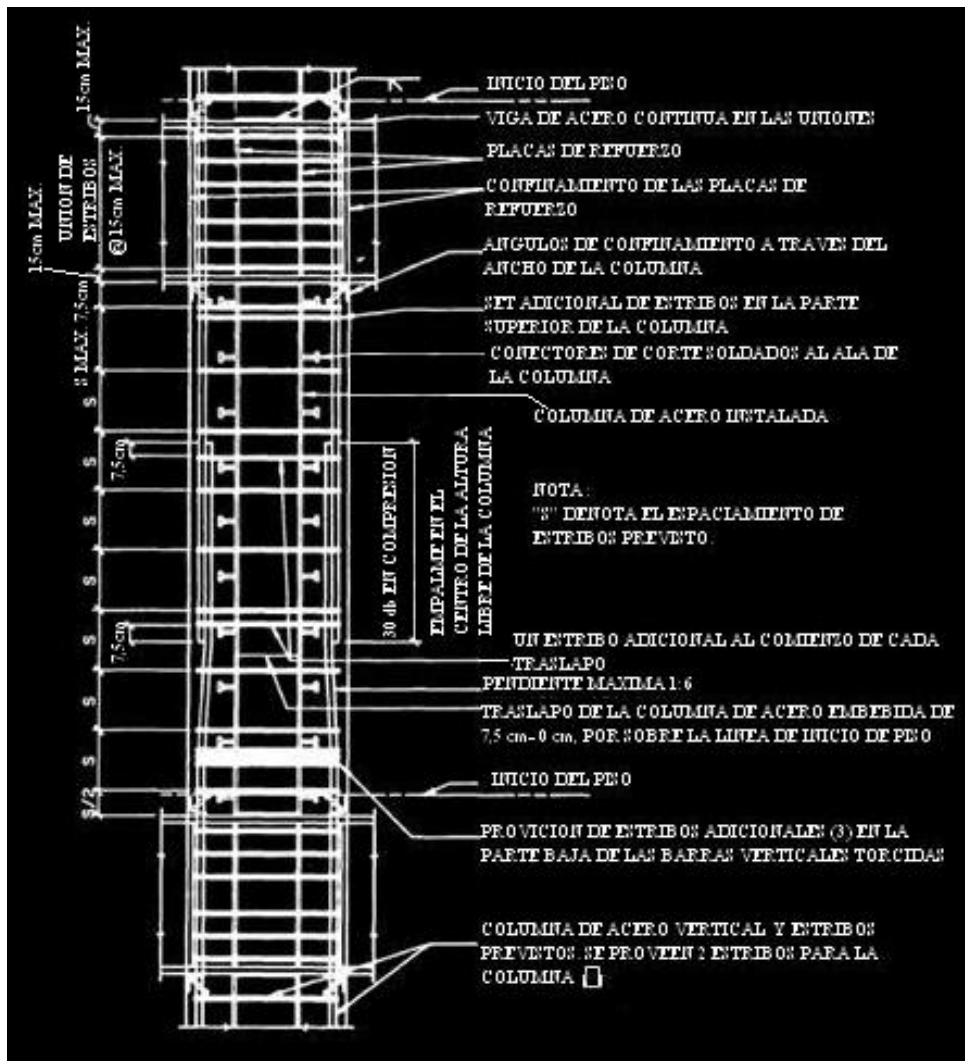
Elevación de una Columna Compuesta SRC [3]
